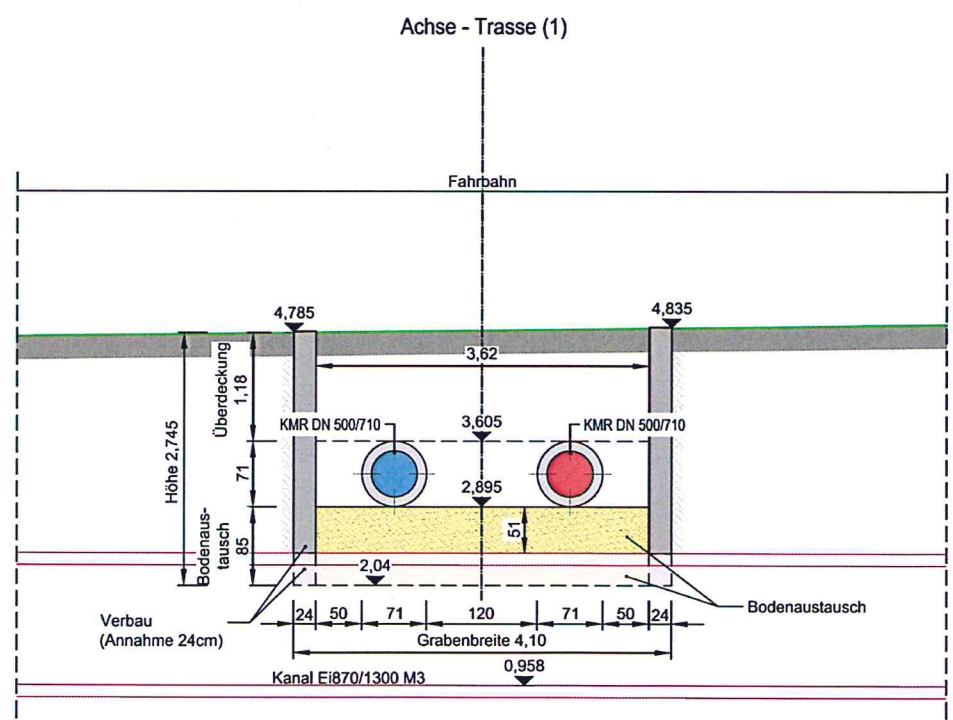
f Schnitt (24.3) Auszug aus dem Plan Nr. 4.24.3.2
